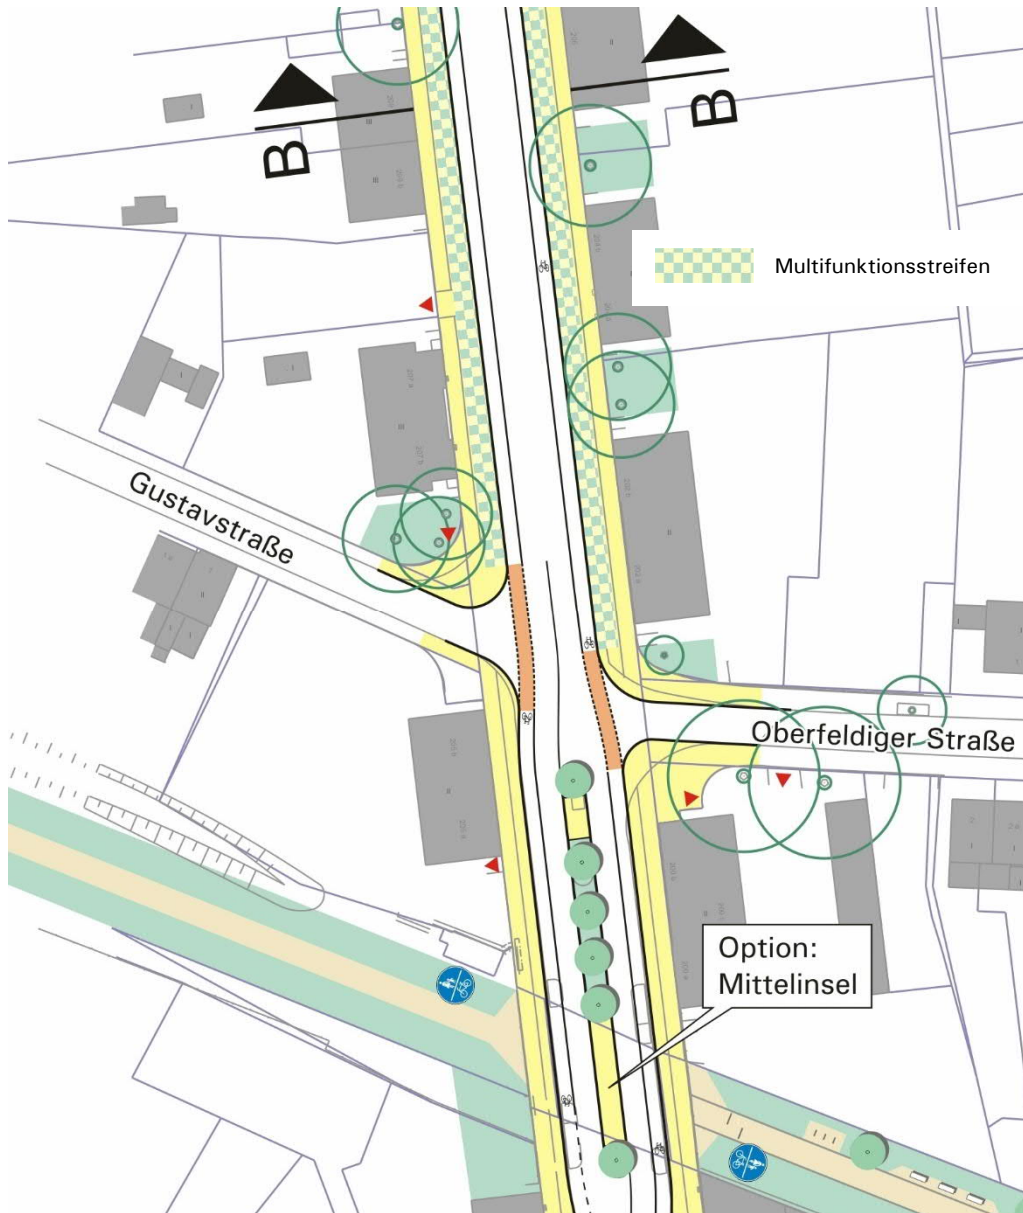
Lageplanausschnitt Gartenstadt – Variante 1 bestandsoptimiert
